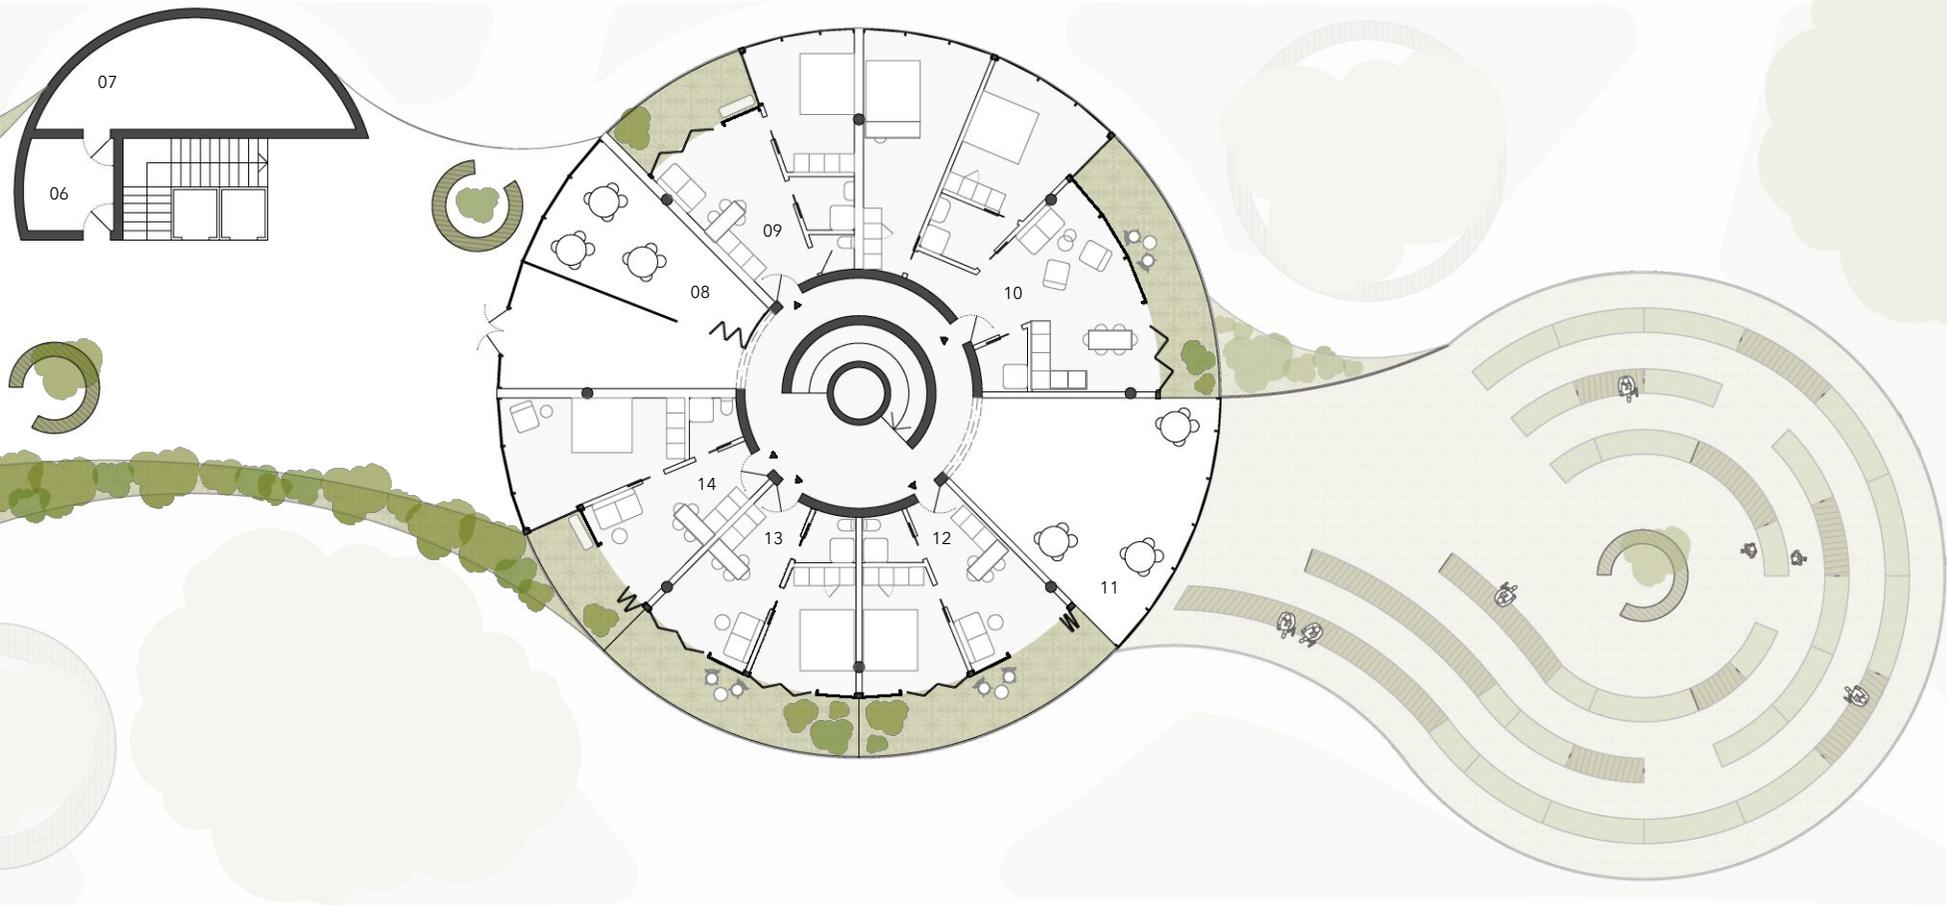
Grundriss 4. Obergeschoss
